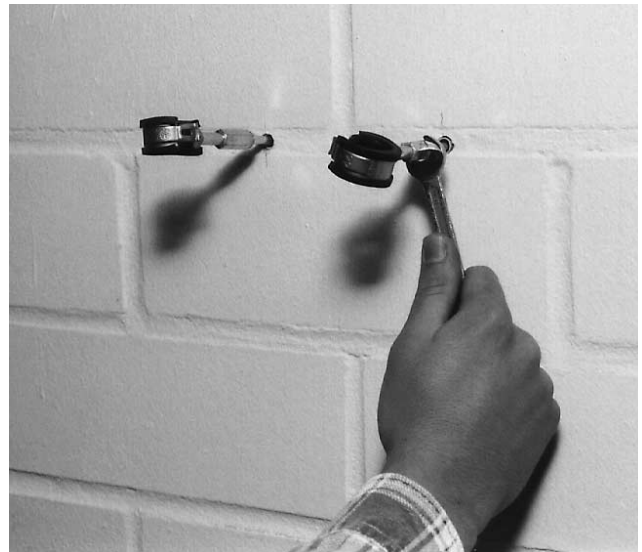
Rohrhalter f. Solarkreis mit 10er Bohrer im Abstand von 125 mm andübeln und Solarkreisrohr mit Schraubendreher festklemmen. Abstand von ca. 100 mm zwischen Rohrmittle und Wand einhalten!
